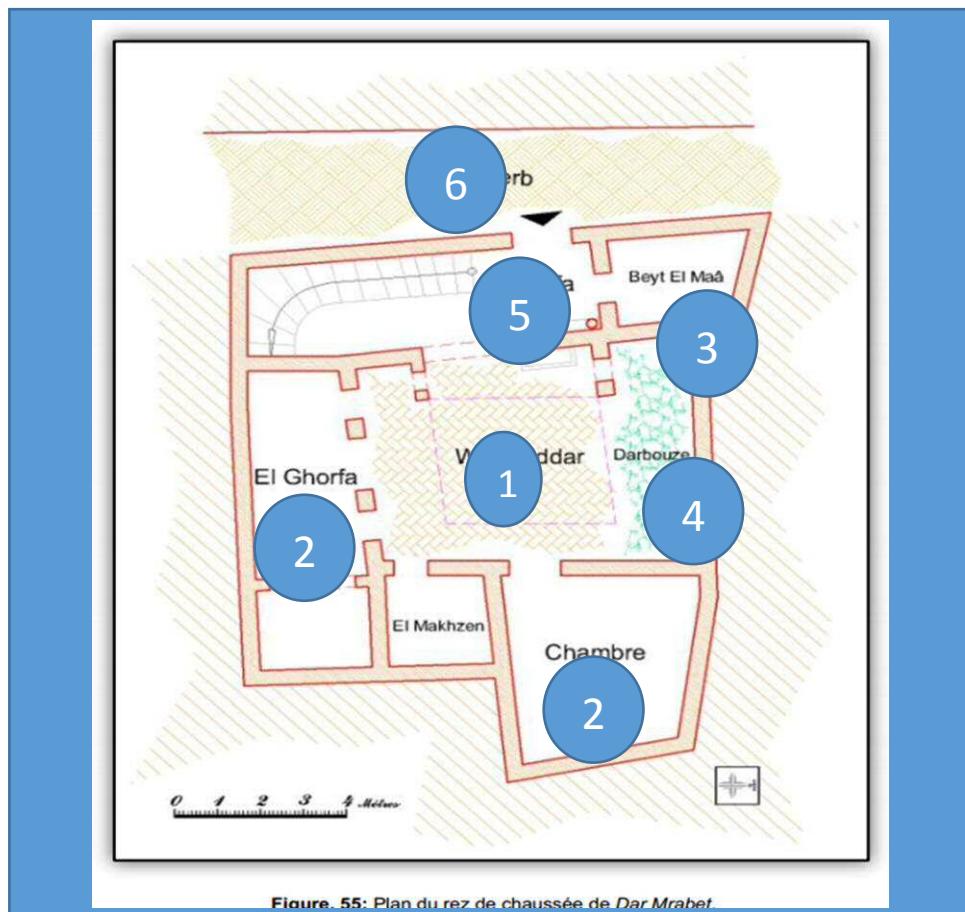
Plan du rez de chaussée de Dar Mrabet
